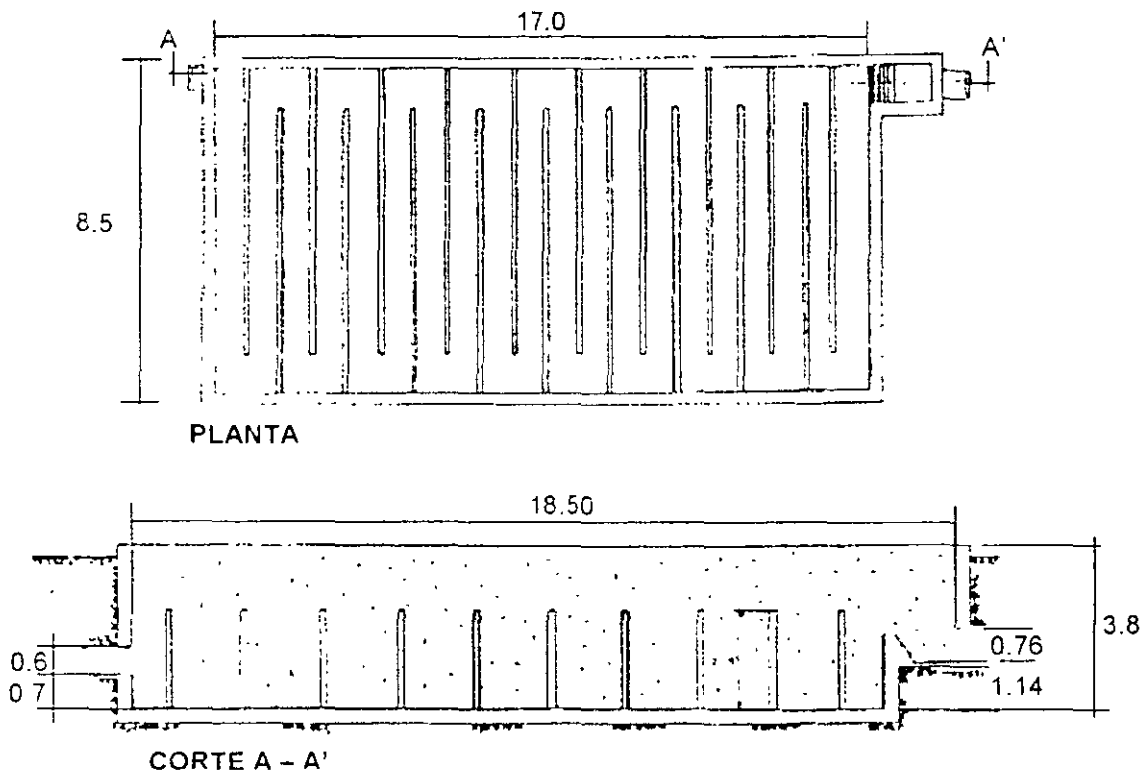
Depósito longitudinal dividido con baffles, con relación largo-ancho mayor de 40-1.
